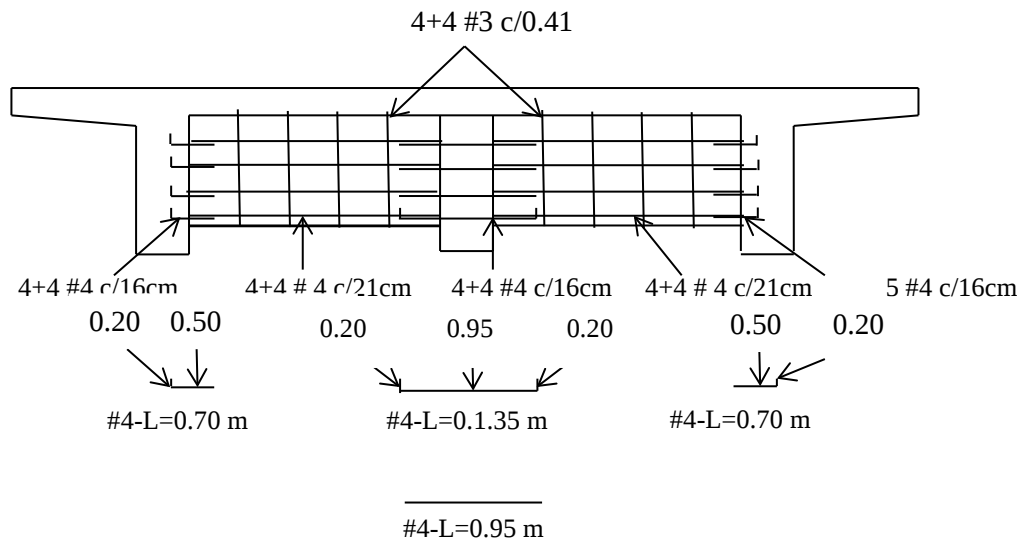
Detalle de armado de la viga diafragma central, vista longitudinal del diafragma.
